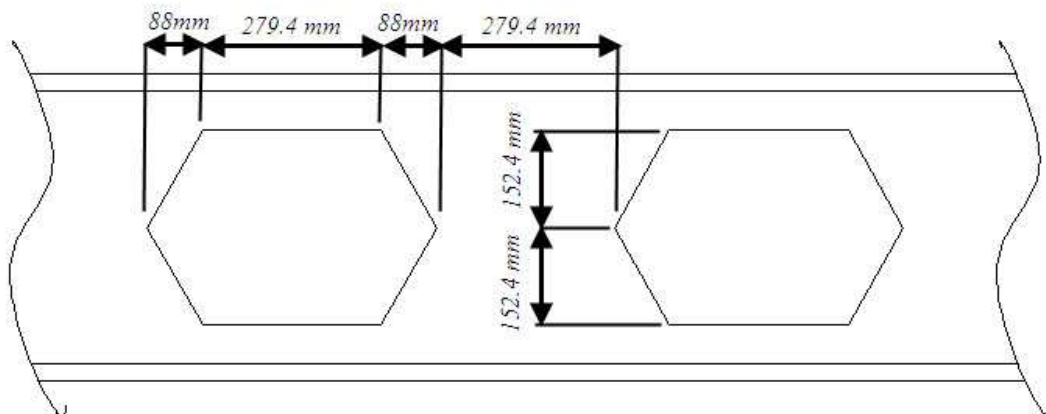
Detalle de las aberturas en el alma de la viga casteleada
